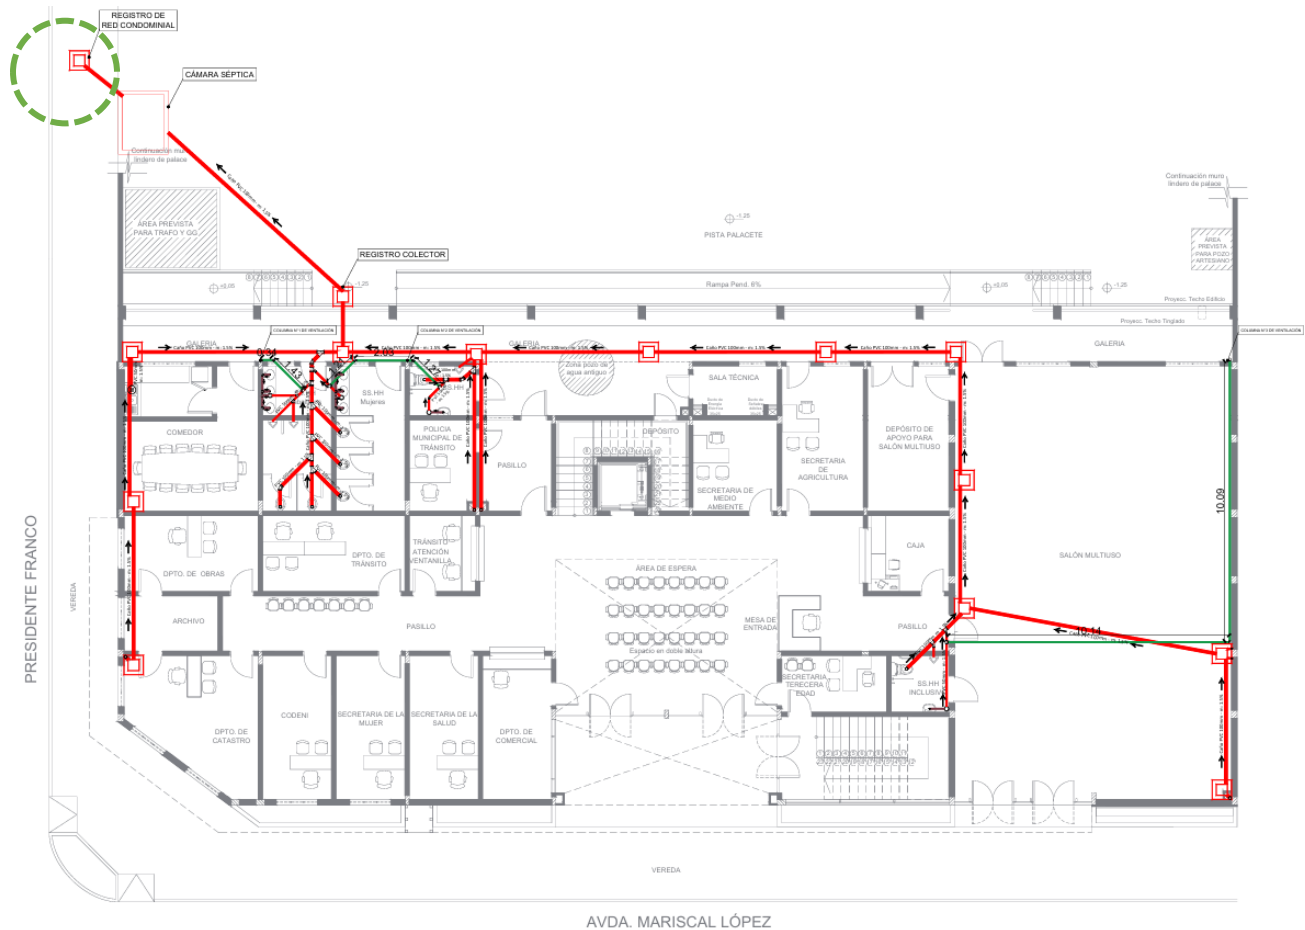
Esquema de desagüe cloacal de planta baja del Edificio Municipal
